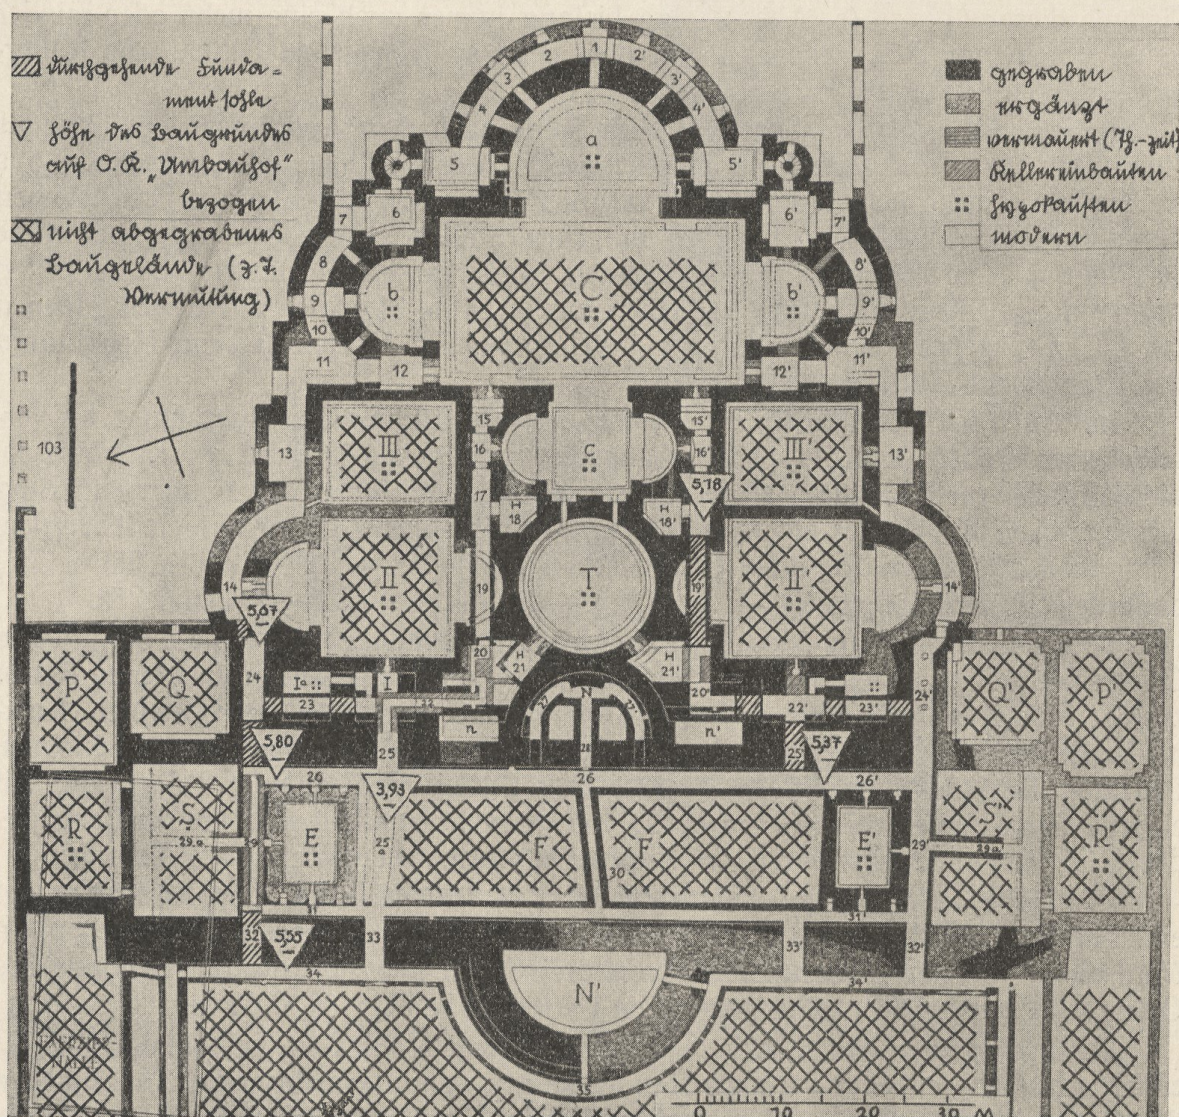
Kellergang-Grundriss aus „Krencker-Krüger, Die Trierer Kaiserthermen Bd. I“. Es sind die bei der jetzigen Untersuchung ermittelten Höhen des Baugrundes eingetragen; ausserdem die über die Gang-Sohlen durchlaufenden Fundamentsohlen der aufgehenden Mauern des Erdgeschossgrundrisses. Es ist versucht worden, auf Grund der einzelnen jetzt und früher gemachten Beobachtungen ein gesamtes Bild der Thermen-Baugrube zu geben, d. h. alle die Stellen sind mit Kreuzschraffur angegeben, wo vermutlich das vorgefundene Gelände nicht abgegraben worden ist. Die angegebenen Höhenzahlen beziehen sich auf einen Nullpunkt, der 36 cm tiefer liegt als der den Zeichnungen in „Krencker-Krüger, die Kaiserthermen“ zu Grunde gelegte Nullpunkt.
